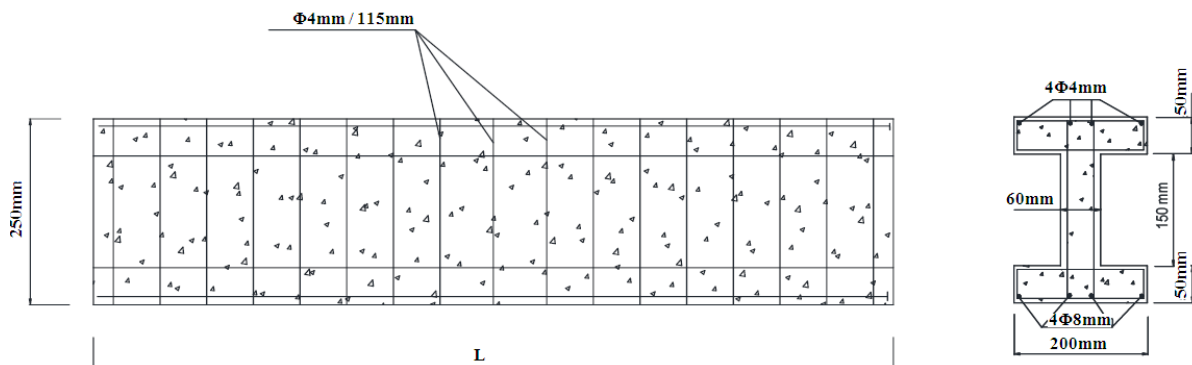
Dimensões e armaduras das vigas de ABED (2012, p.2).
